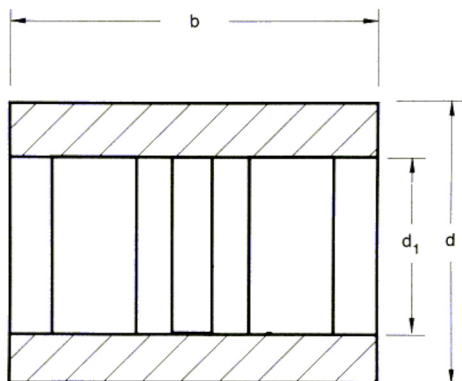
Assentamento de argamassa somente nas faces externas longitudinais da unidade (Face Shell). Fonte: TECHNICAL NOTES 39B, 1988.
